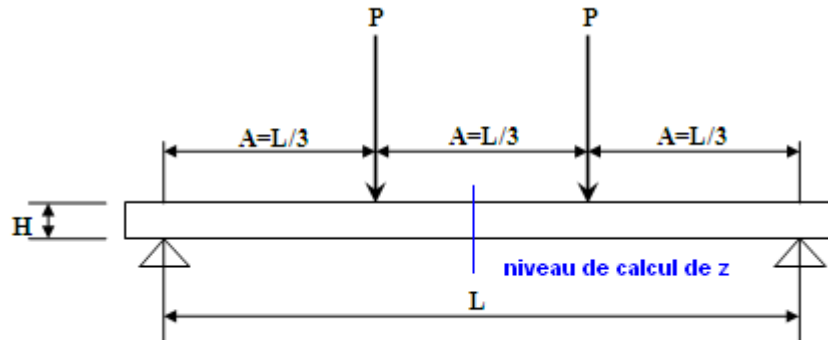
Schéma de calcul du déplacement au centre d'une poutre droite en flexion 4PB
